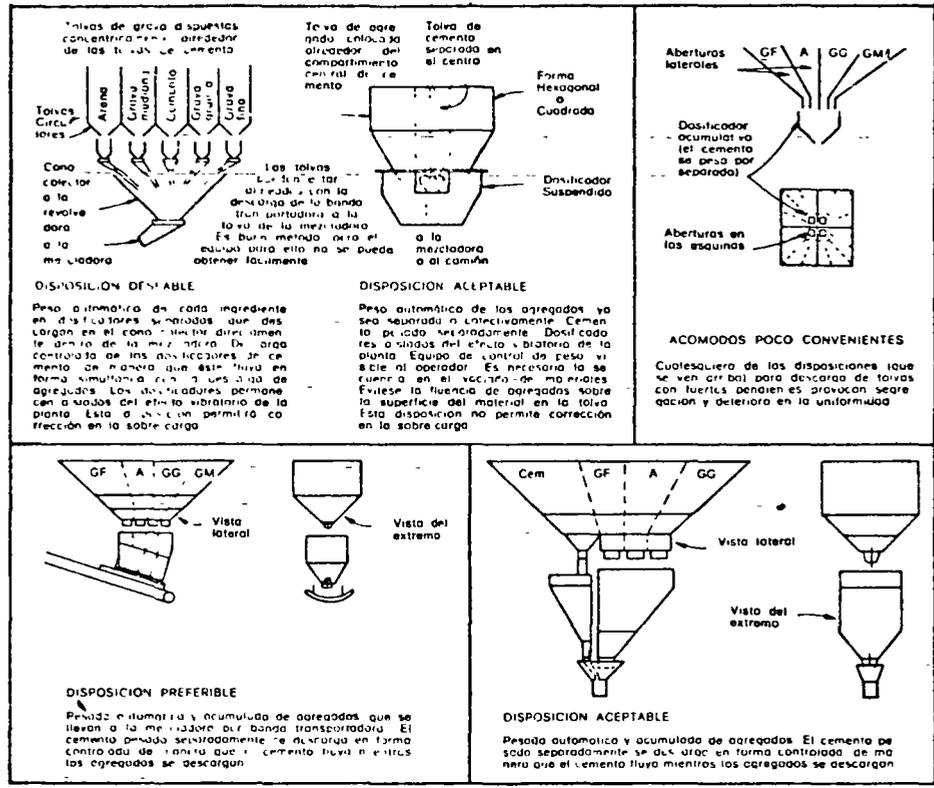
Disposición de las tolvas en la planta de concreto.
